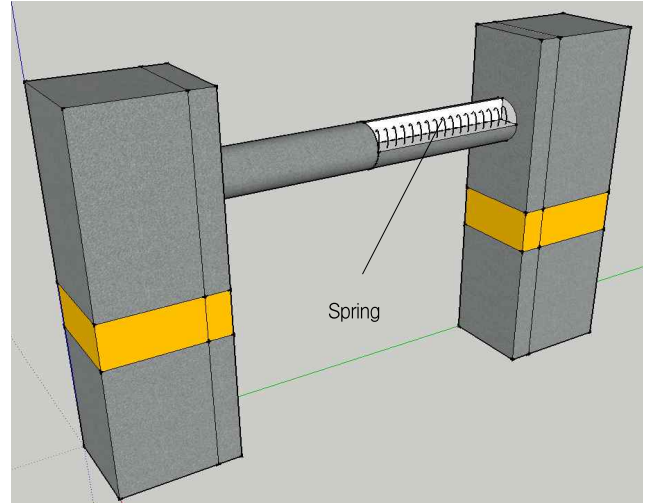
Bridge System CFT(Concrete Filled steel Tube)
